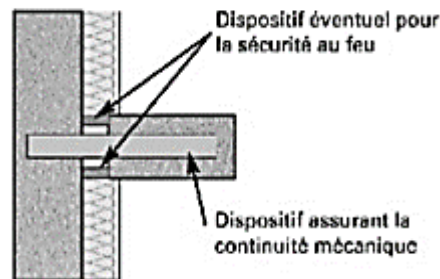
Schéma de principe d'un rupteur pour dalle béton.
